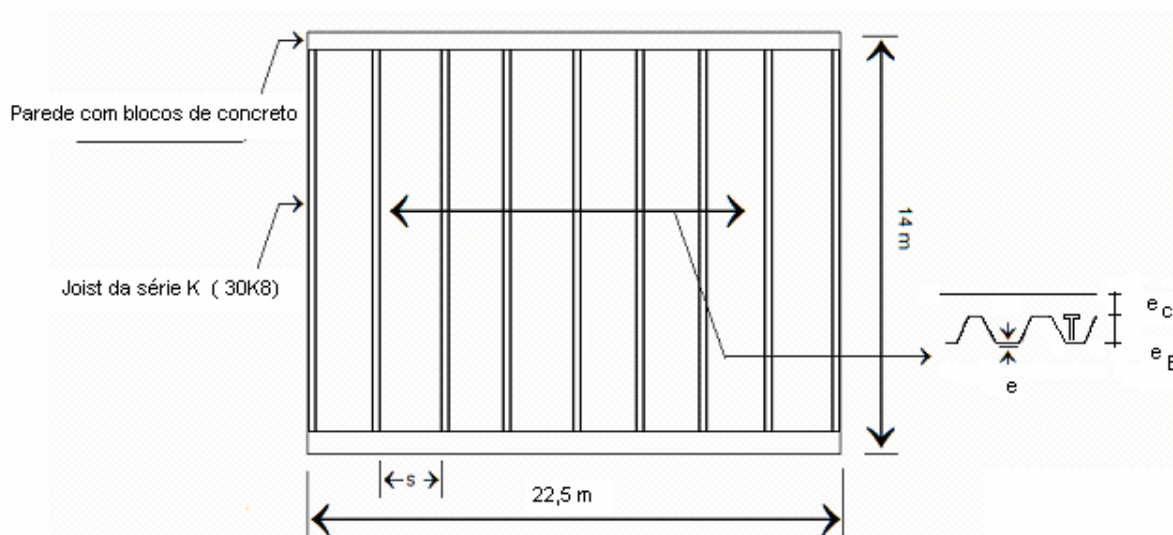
Seção transversal das vigas treliçadas (joists)
